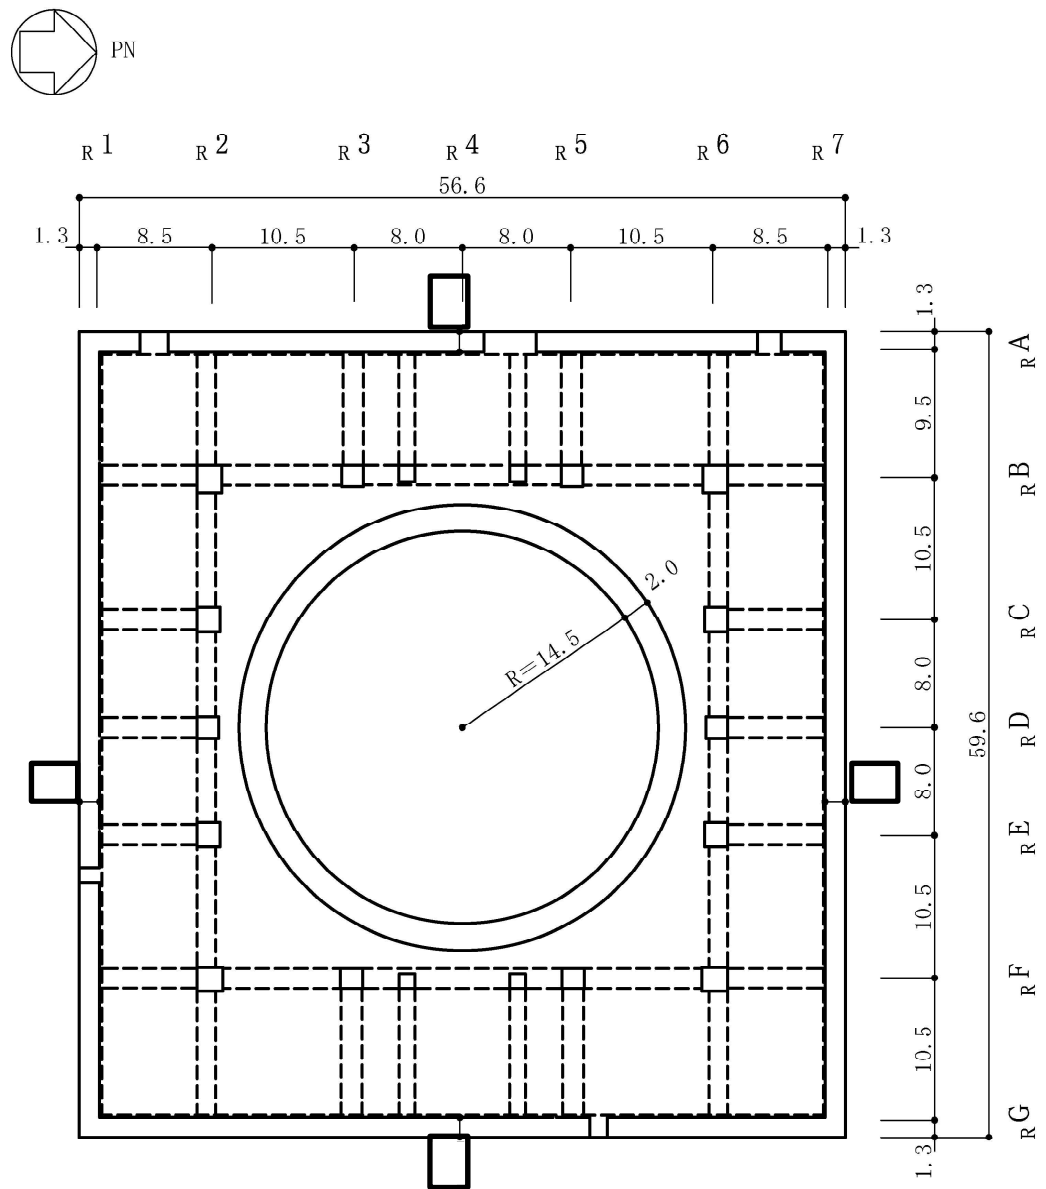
原子炉建屋の概略平面図 (B1F, T.M.S.L. 4.8m) (3/9) (単位 : m)
